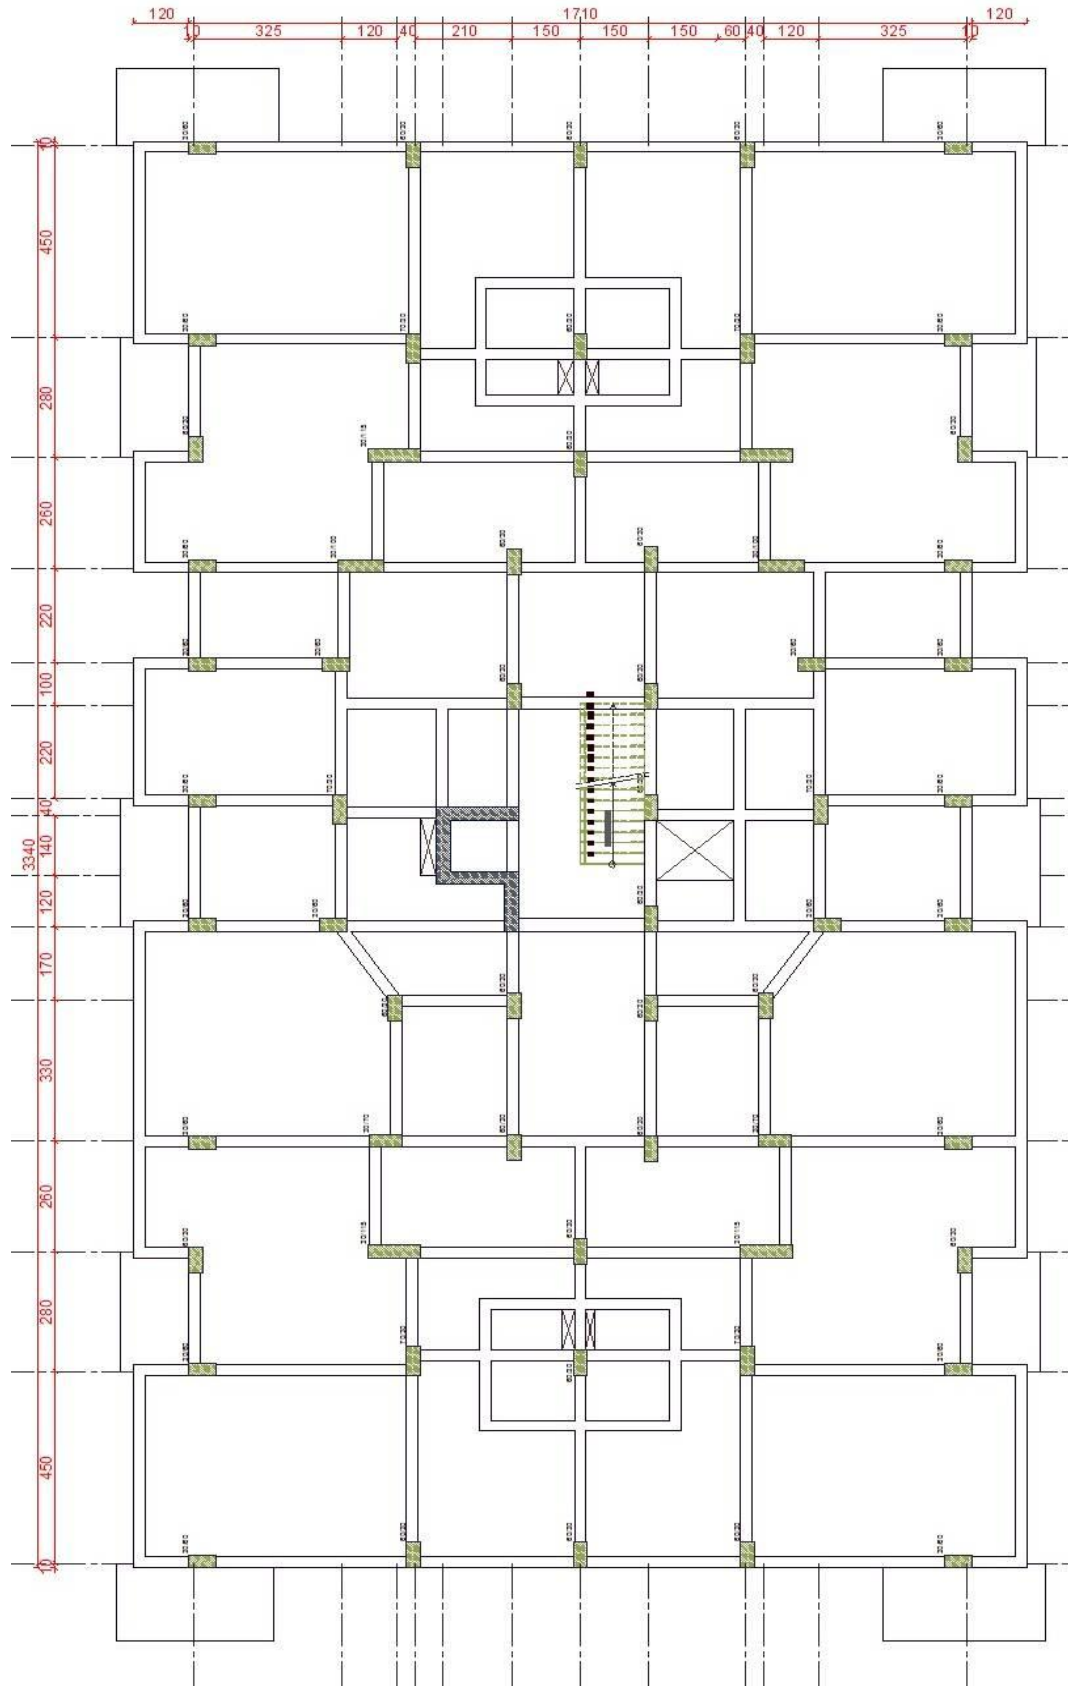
Yapının mevcut temel aplikasyon planı
